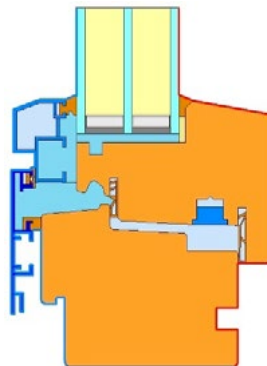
DH okno s izolačním trojsklem – profil tloušťky 88 mm (DH 88_T)
